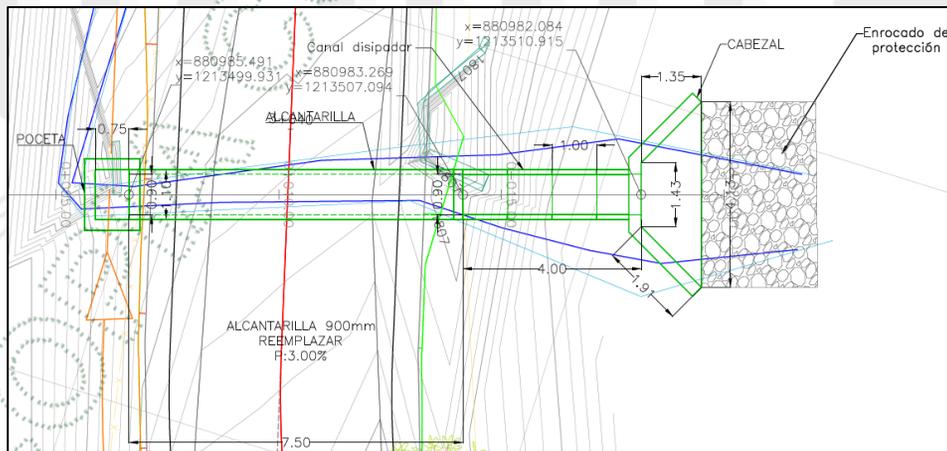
4(41)						Tipo de la obra		Tubería abscisa K02+957
